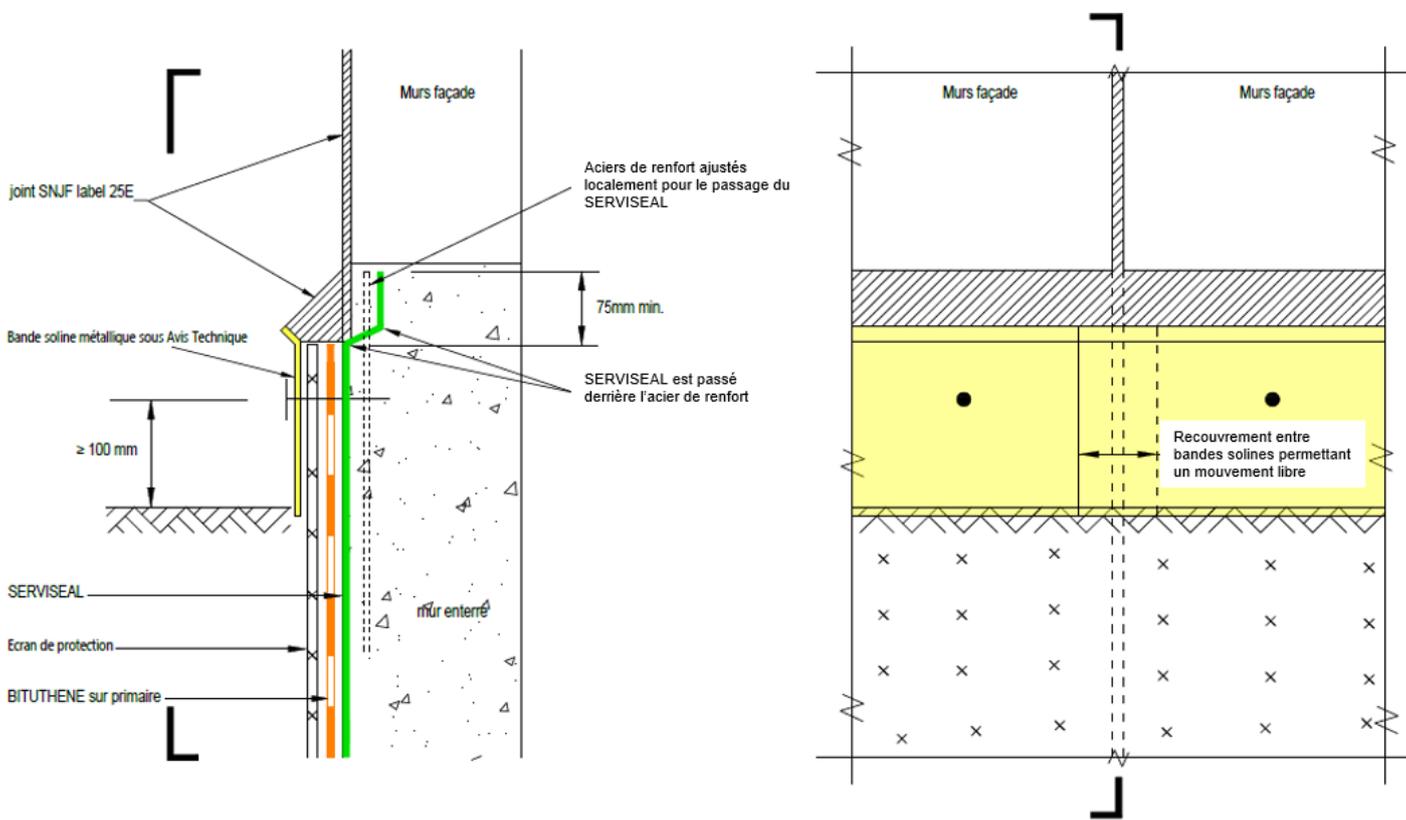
Arrêt en partie haute au droit d'un joint de dilatation
